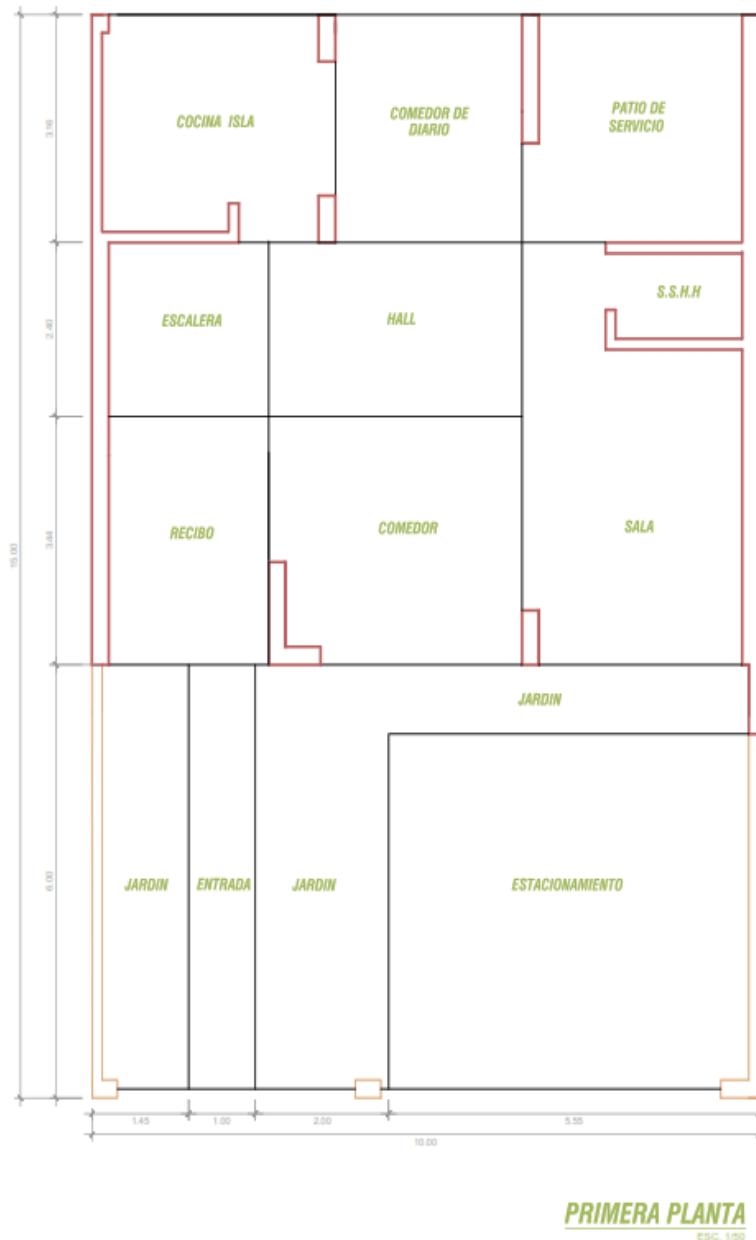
Área del Terreno y Diseño de Estructural de la Vivienda.
